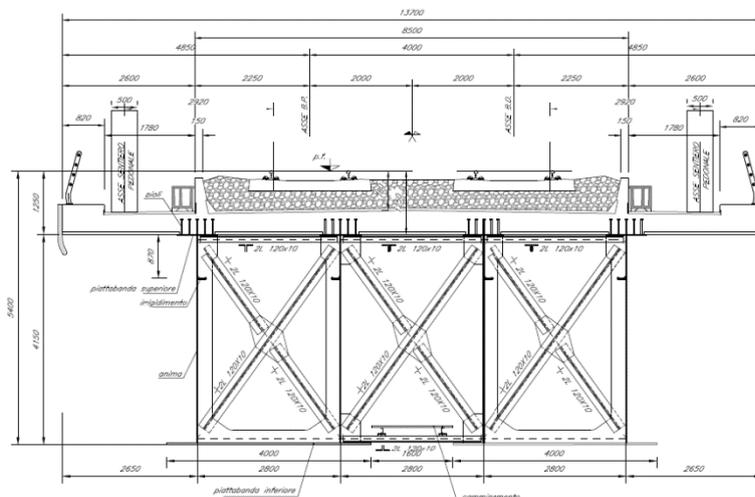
Sezione trasversale tipo (H travi = 4,15m) – estratto dalla Relazione di calcolo del Progetto di Gara
